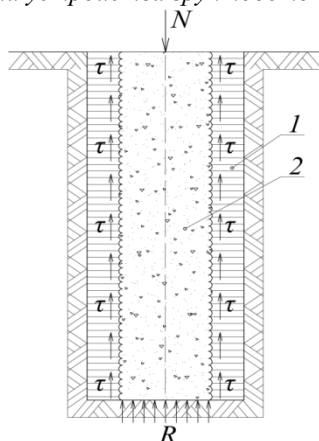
Схема к определению несущей способности сваи SFA (НПШ) по грунтоцементному основанию F_{dl} 1-грунтоцементный массив, 2 – свая SFA (НПШ).
